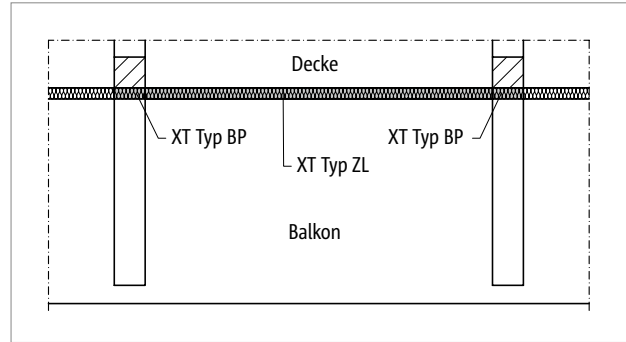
Schöck Isokorb® XT Typ BP: Balkonkonstruktion mit frei auskragenden Unterzügen
